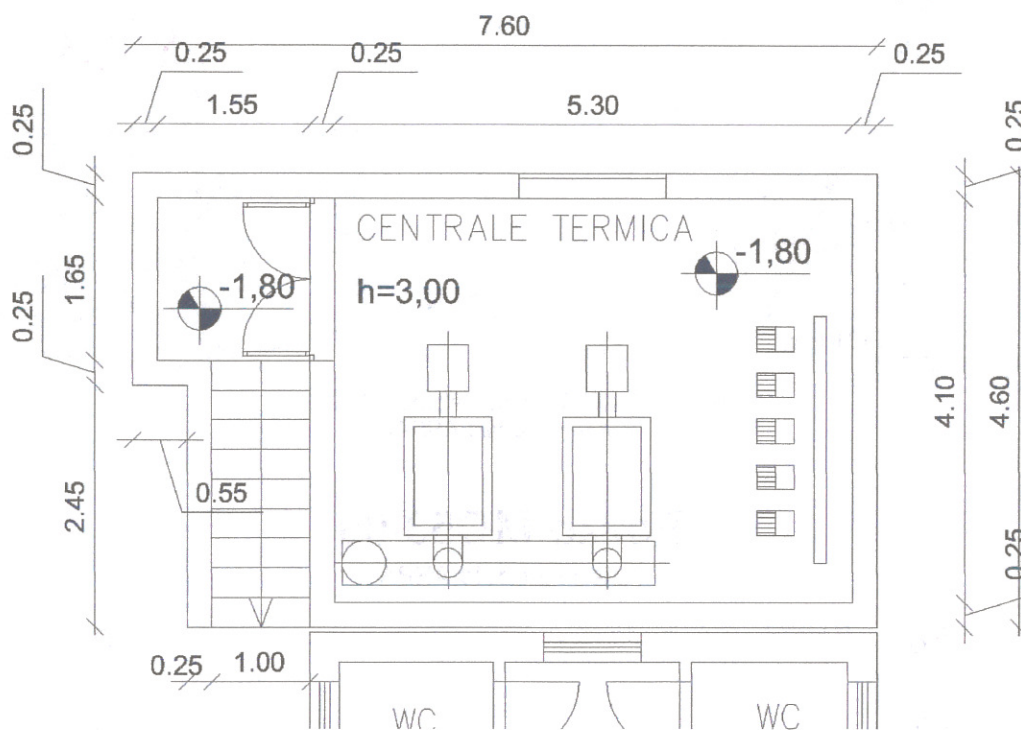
Planimetria della centrale termica (fuori scala)
